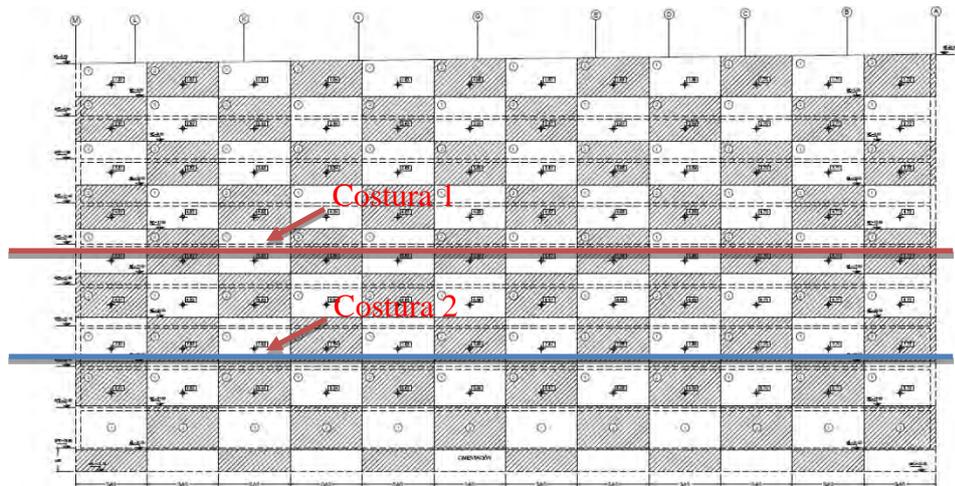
Imágenes de muros anclados en los que se aprecia las dos costuras. Costura 1: zona de encuentro de paños construidos y picado de cachimba. Costura 2: Intersección entre losa y muro.
